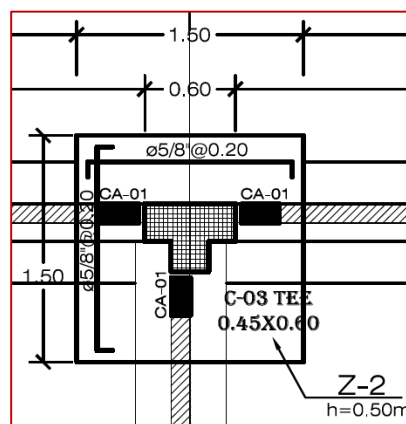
Disposición de Acero de la Zapata Aislada Ubicada en la Intersección de los Ejes "A" y "3" del Módulo: Aulas
